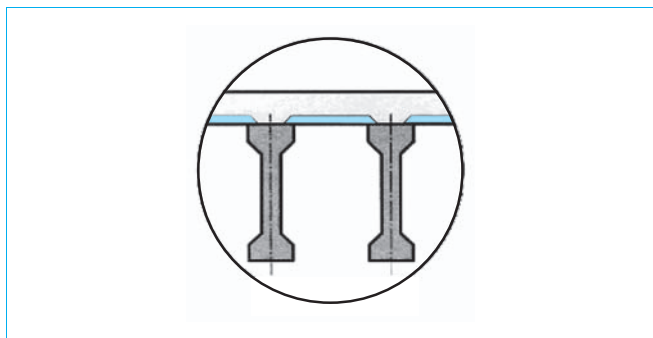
Coupe schématique d'un tablier à poutres précontraintes par pré-tension
